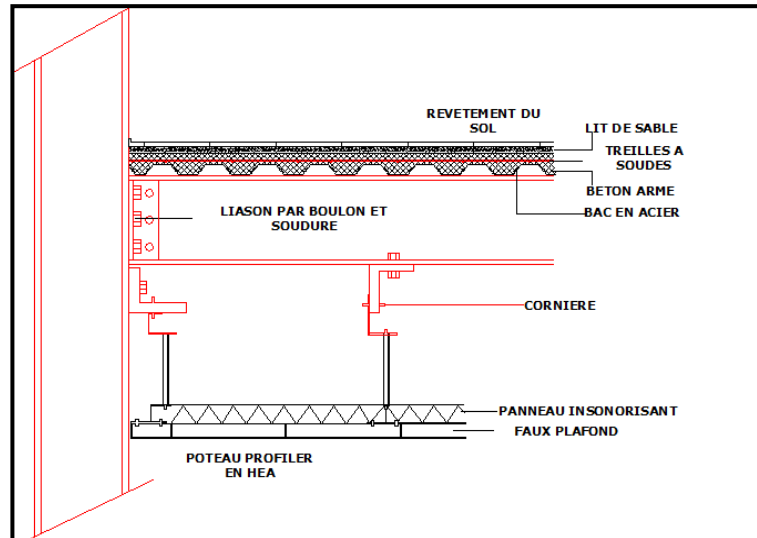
Schéma d'un détail d'attache d'un plancher collaborant et un mur Source : Auteurs
